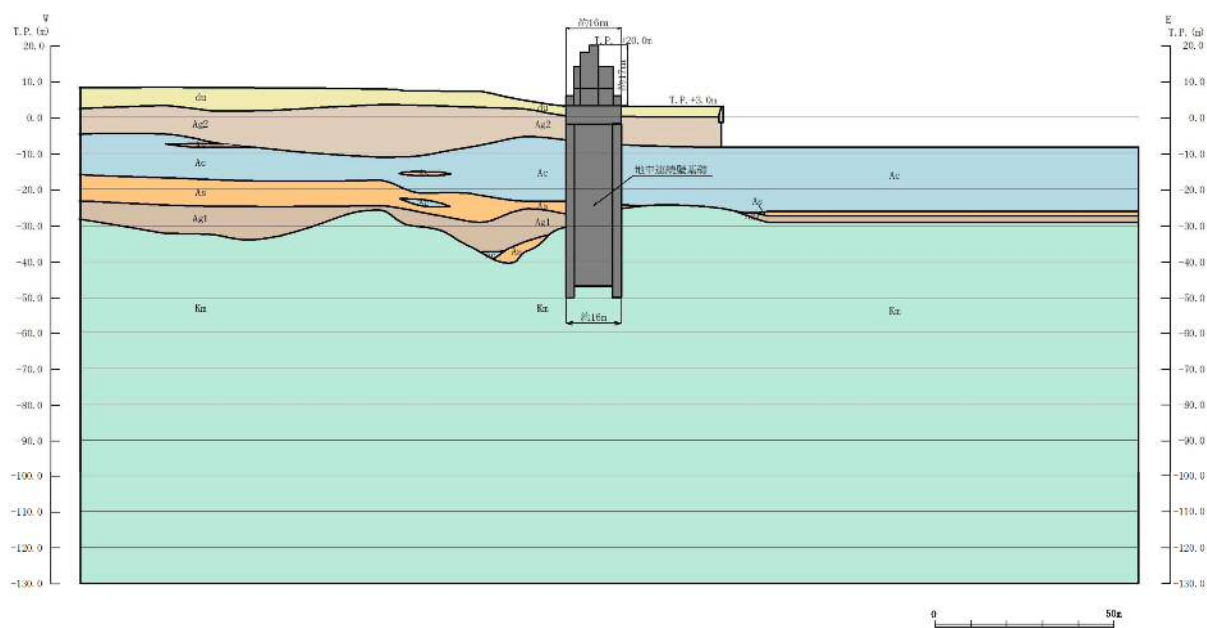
(3) 鋼製防護壁断面図(C-C断面)
